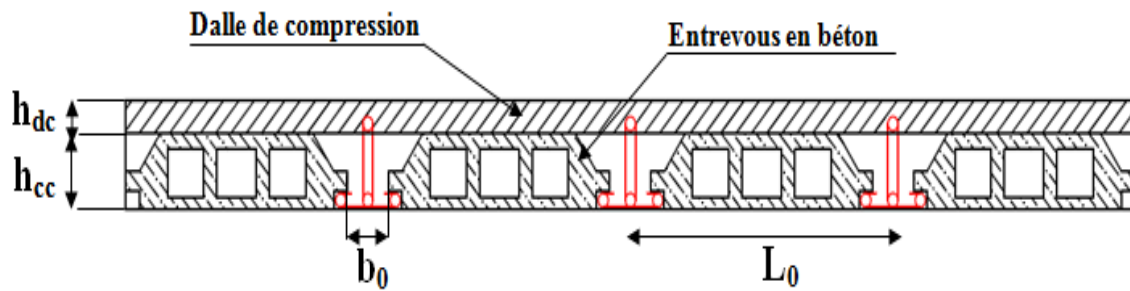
Coupe transversale d'un plancher à entrevous.
